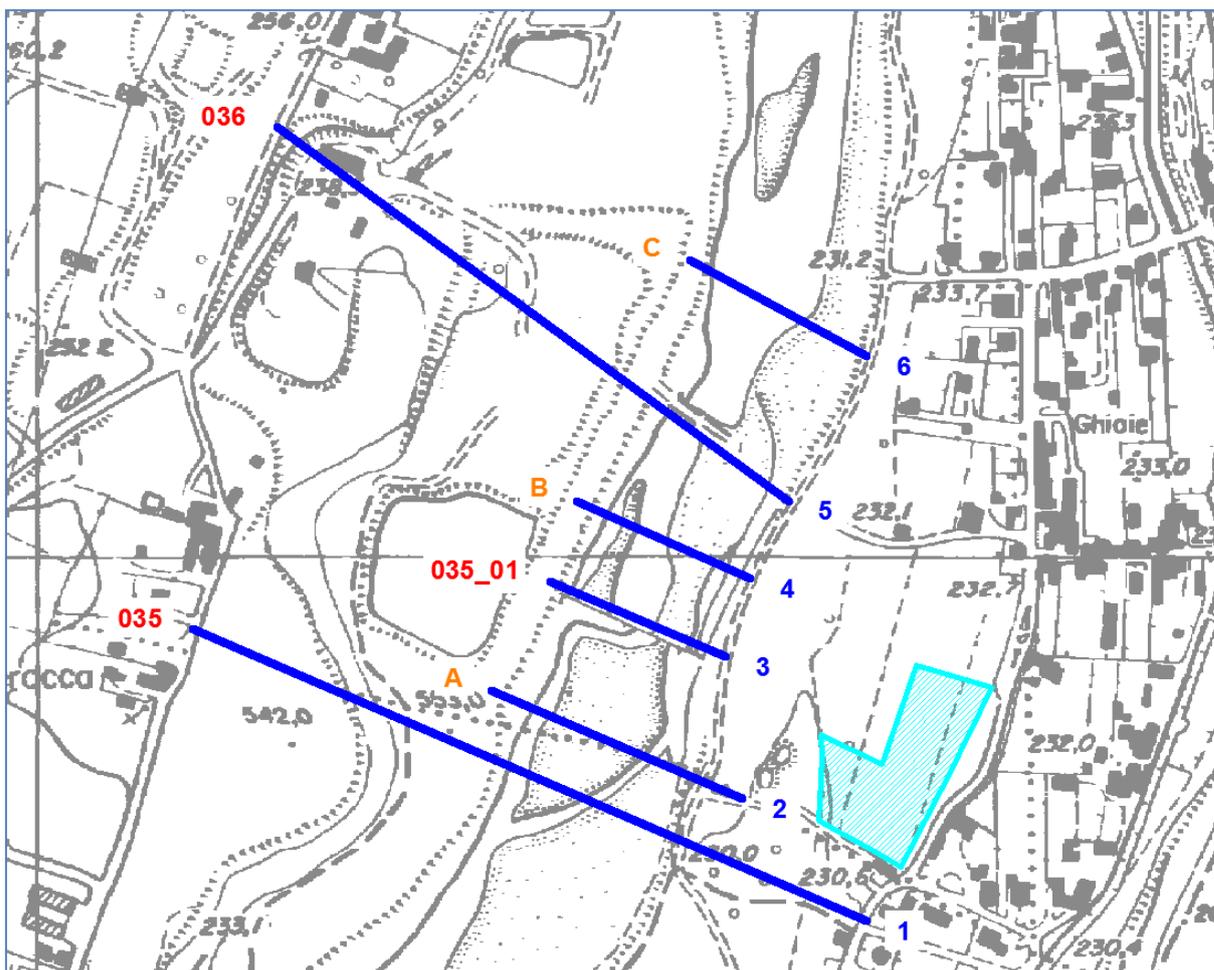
Traccia planimetrica sezioni (in azzurro l'area di intervento)
